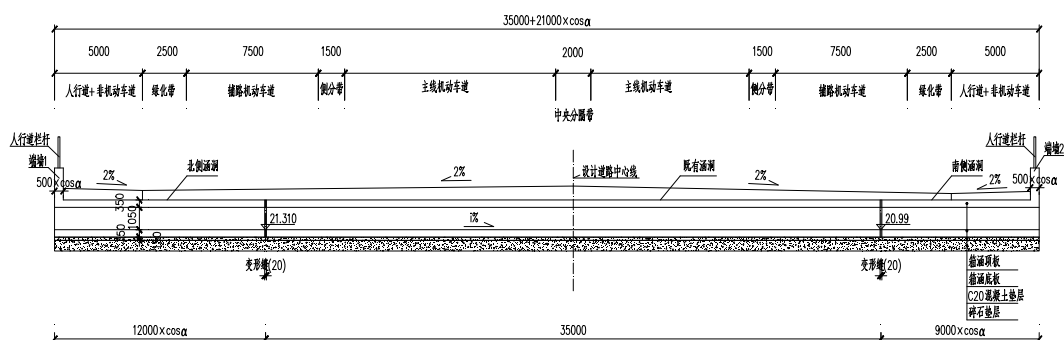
接长更合大道箱涵立面图 (单位: mm)
